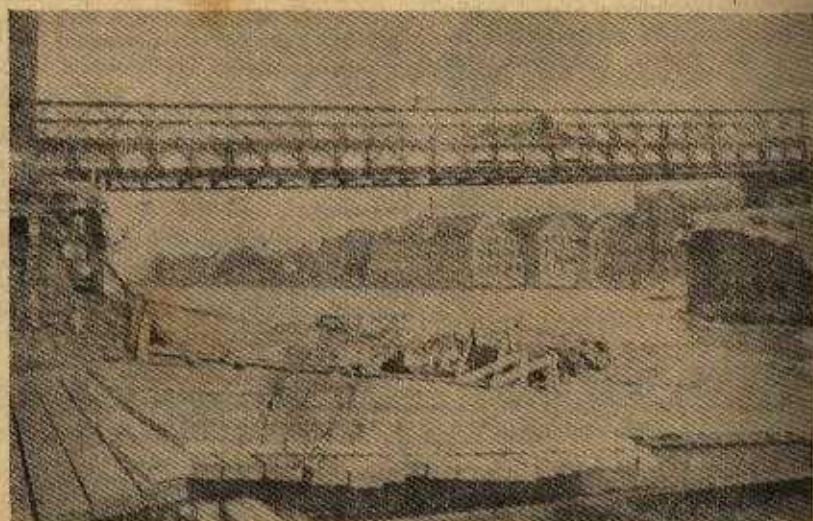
A ponte de circunstância construída sob a Bailey, na brecha Norte, em Regensburg
